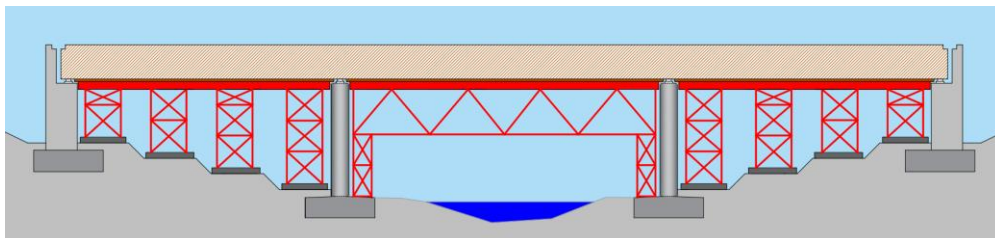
Výstavba mosta pomocou pevnej skruže.
